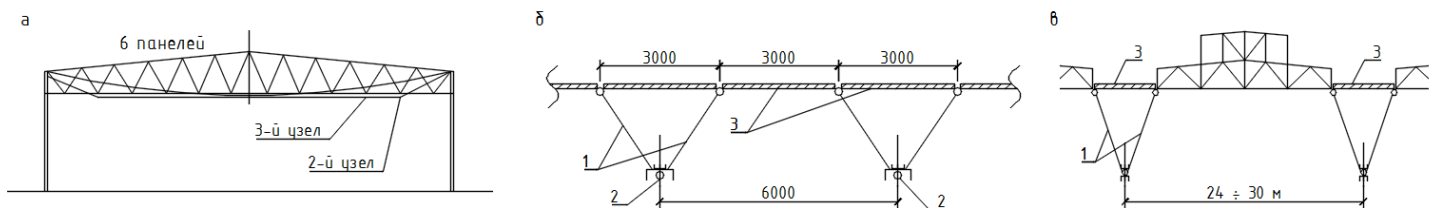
а - поперёчный разрез; б, в - варианты продольных разрезов; 1 - трёхгранная ферма, 2 - затяжки, 3 - железобетонные кровельные плиты.
